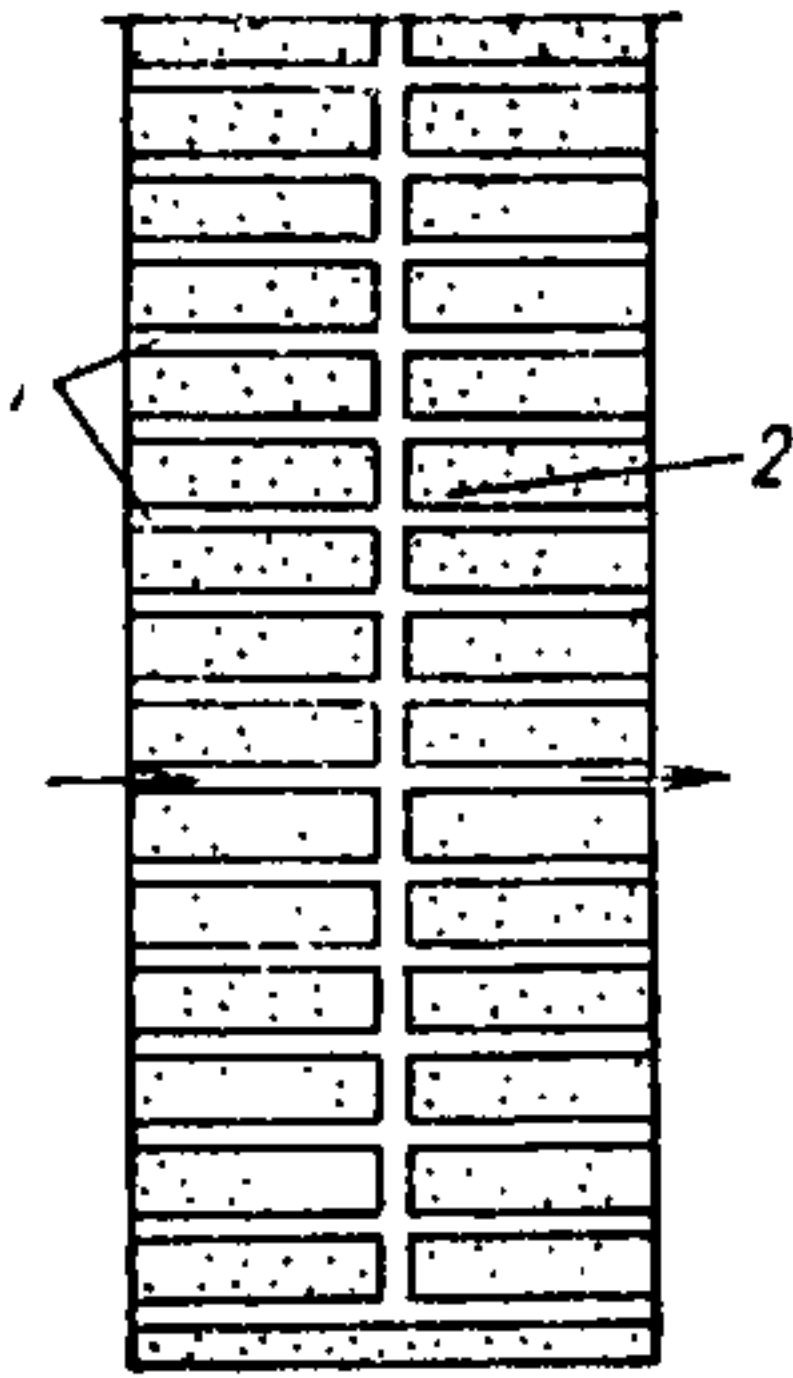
Схемы устройства осушающих вентиляционных поперечных каналов
